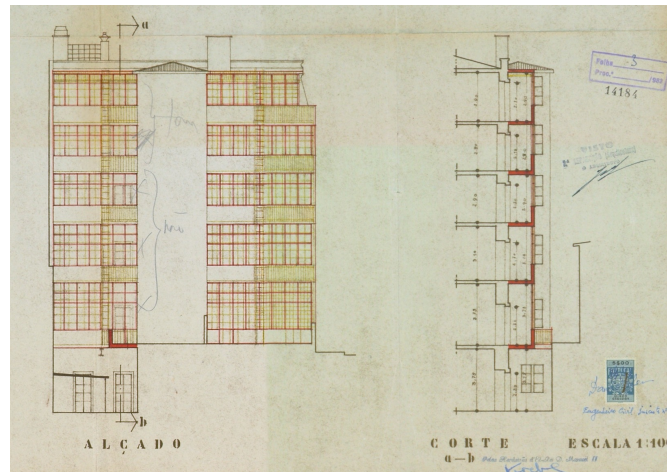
Fachada e corte do projeto de alteração de 1953 (CML, 1953).
